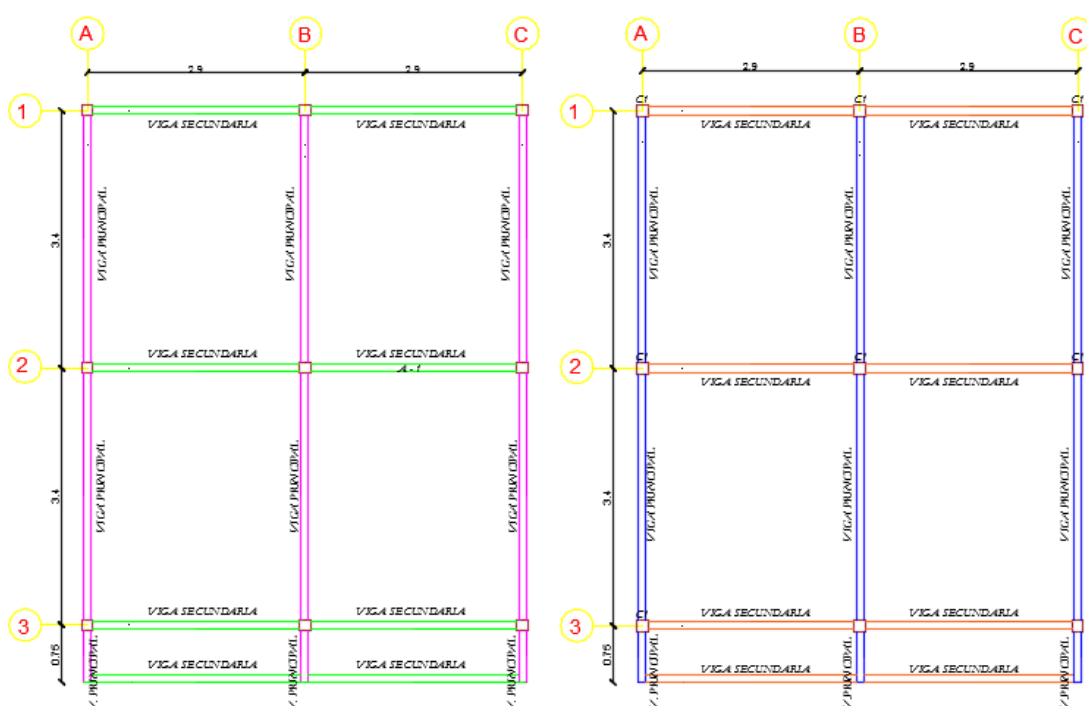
Vigas Principales (TRABE) y Secundarias Primera Planta
